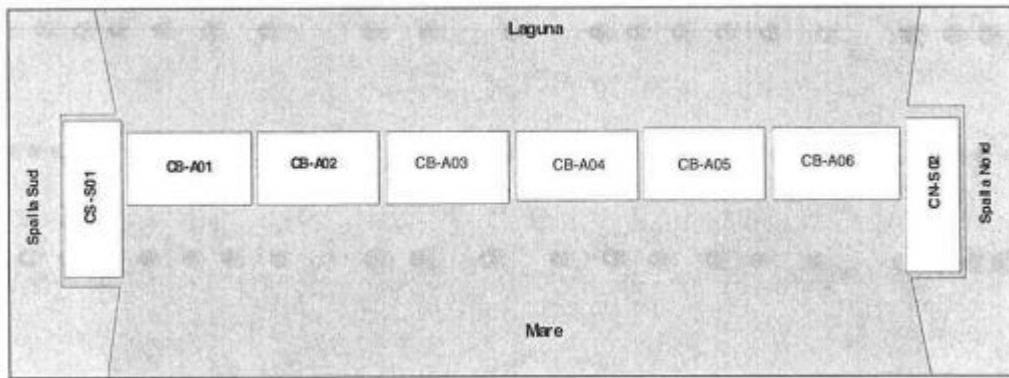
Rappresentazione in pianta della barriera di Chioggia; estratto dagli elaborati grafici AS BUILT.
